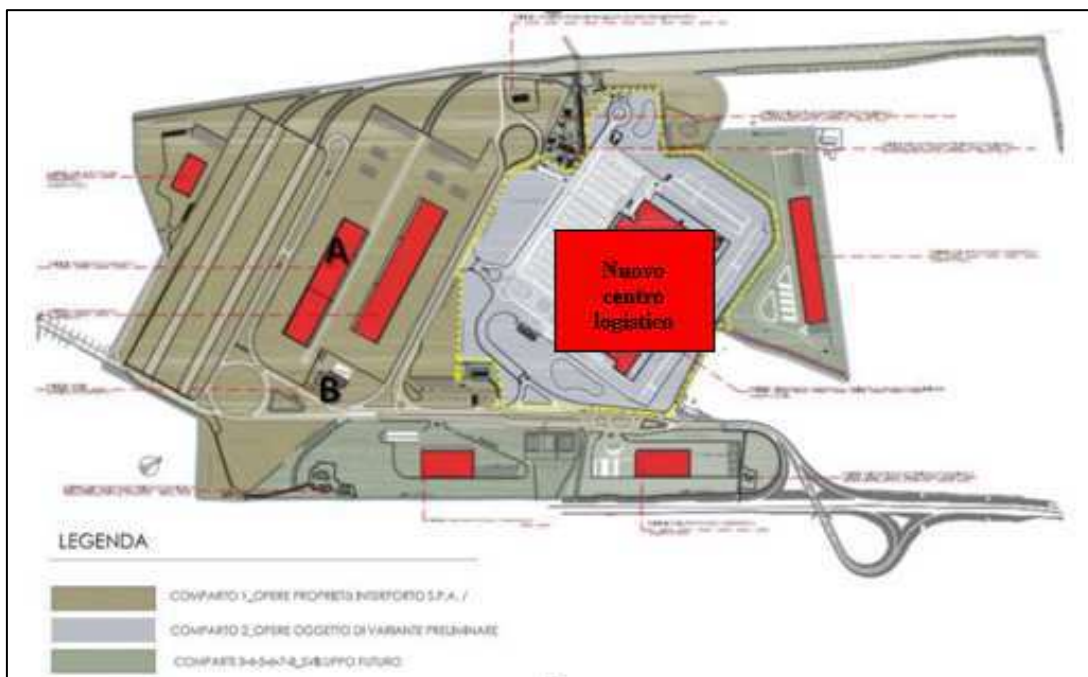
Planimetria generale di sviluppo dell'Interporto di Jesi: evidenziazione delle fasi di sviluppo previsto
